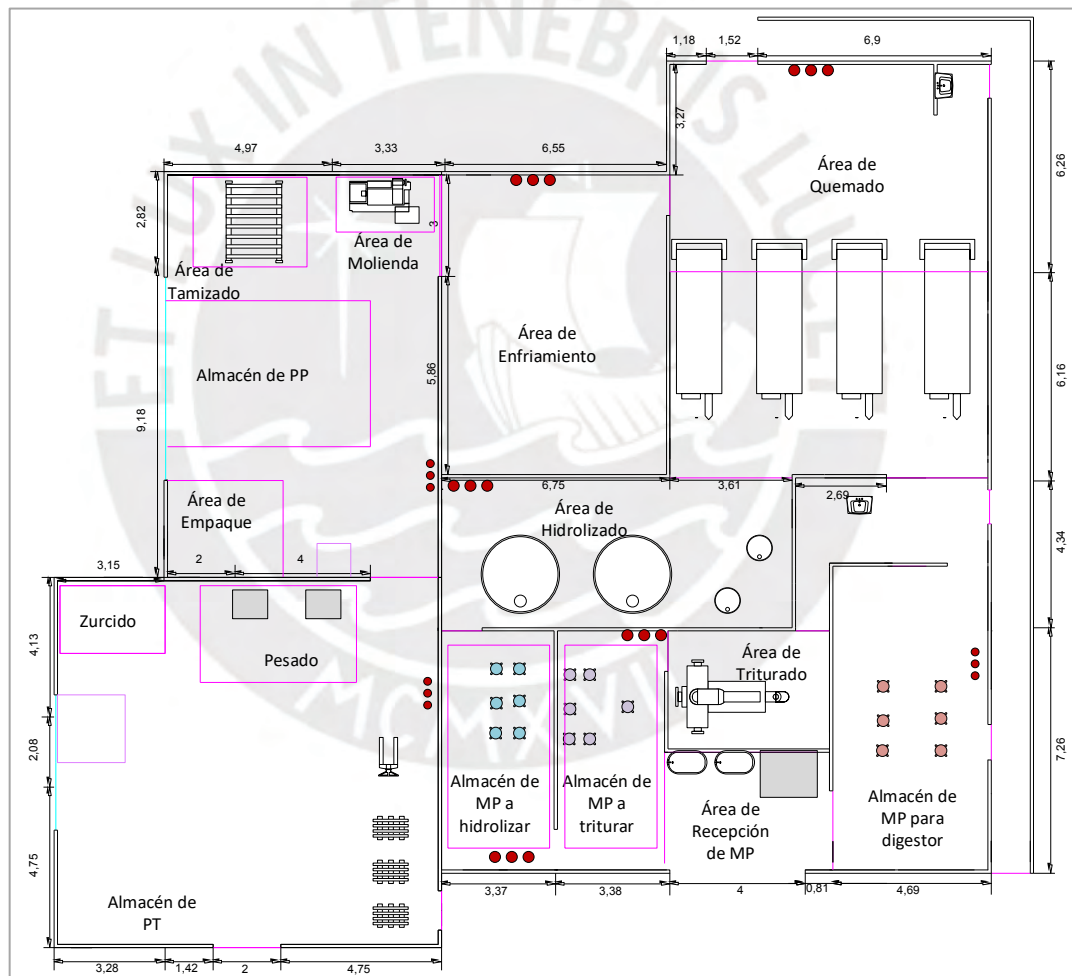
Layout Propuesto. Elaboración Propia
